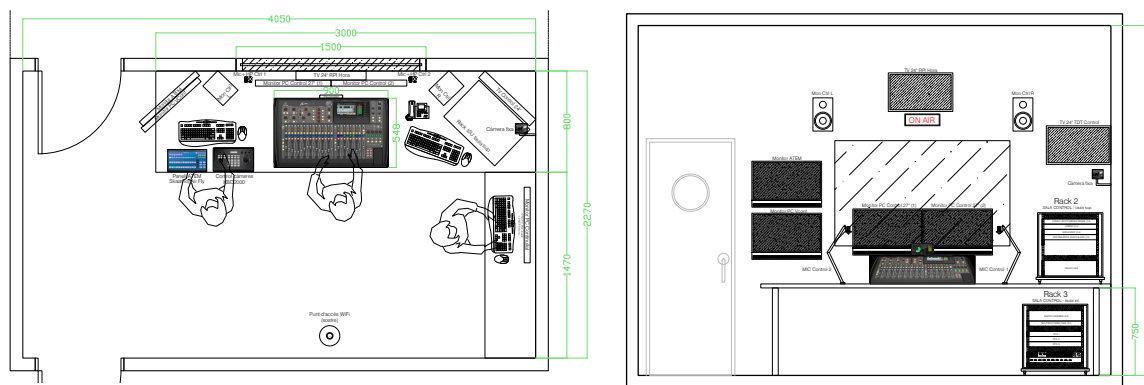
Disseny CAD de la sala de control, vista de planta (esquerra) i vista frontal (dreta)
